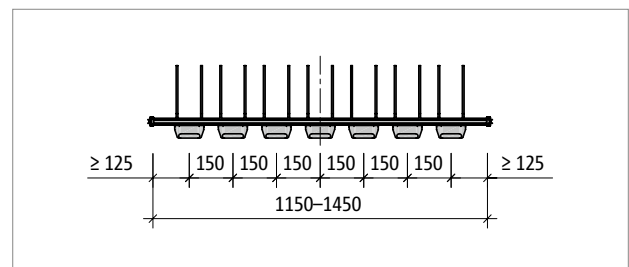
Schöck Tronsole® Typ T-V7-...-L1150 bis L1450: Produktgrundriss
